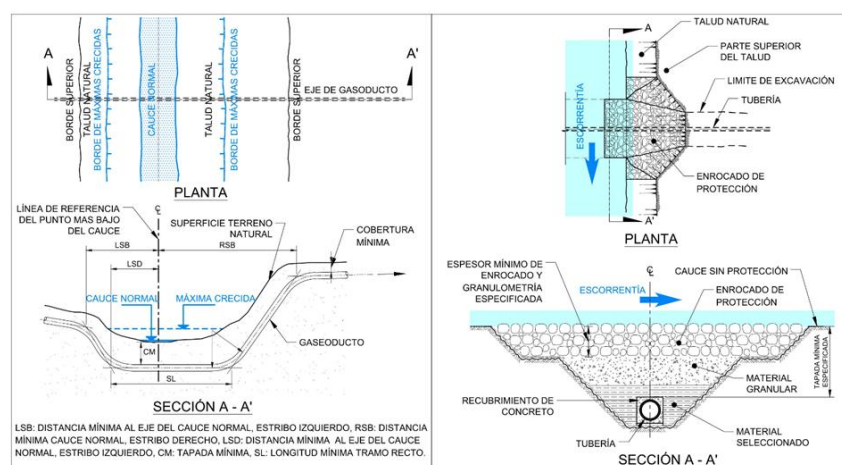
Elementos que necesitan ser definidos para el cruce de tuberías en los cursos de agua y esquema de tubería instalada y obras de protección (plantas y secciones).
